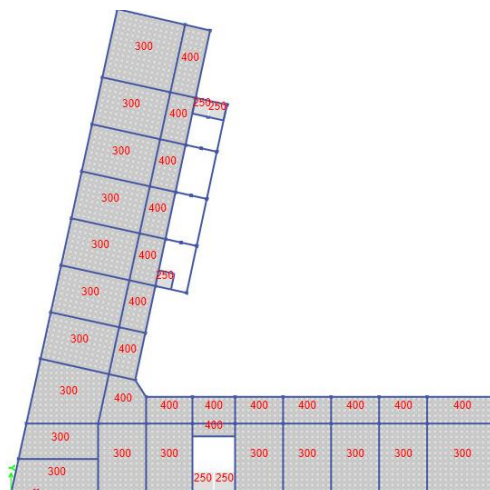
Carga viva en losas (kg/m²) Niv. (+4.15) (Planta Baja)
